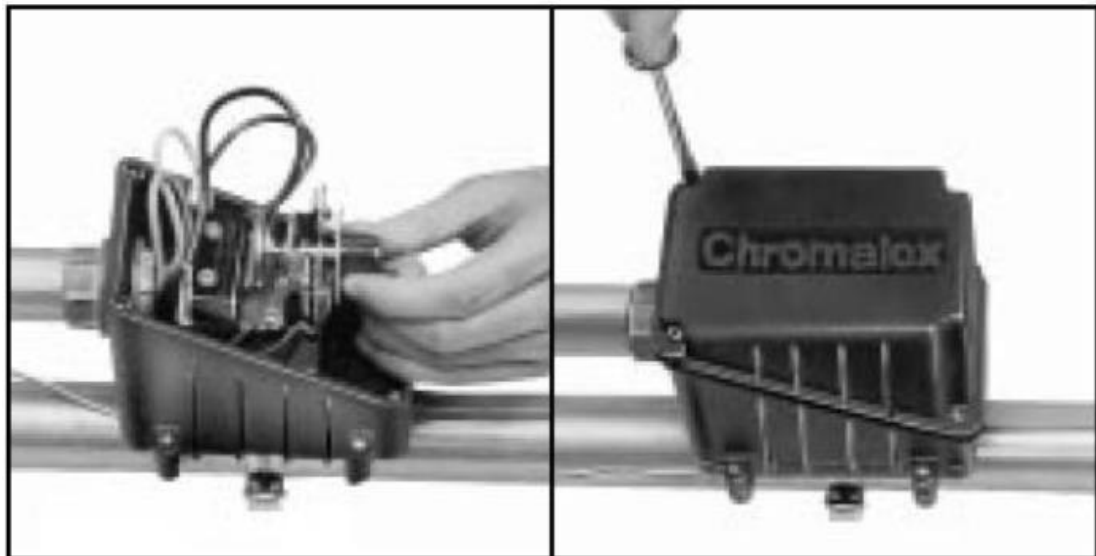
Ajuste de termostato y montaje de tapa final.
